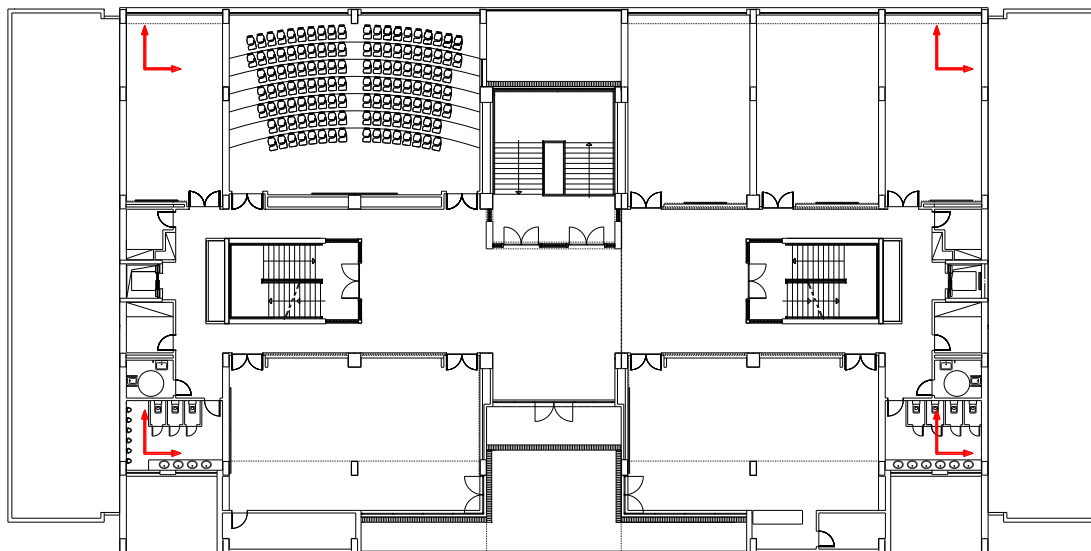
Disposição dos acelerômetros em planta localizado no 3º piso para o edifício objeto de estudo.
